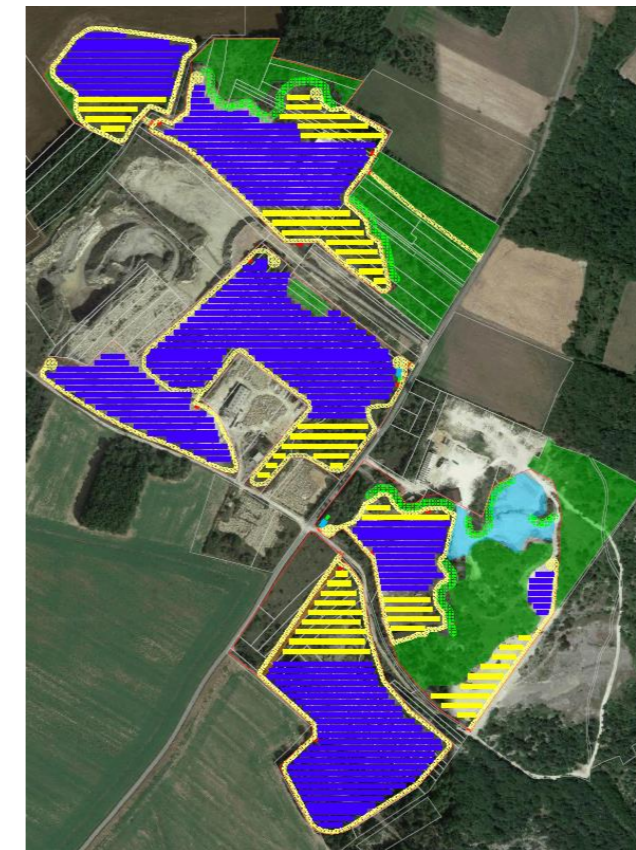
Plan d'implantation du projet (en jaune les tables avec un écartement de 7m)
